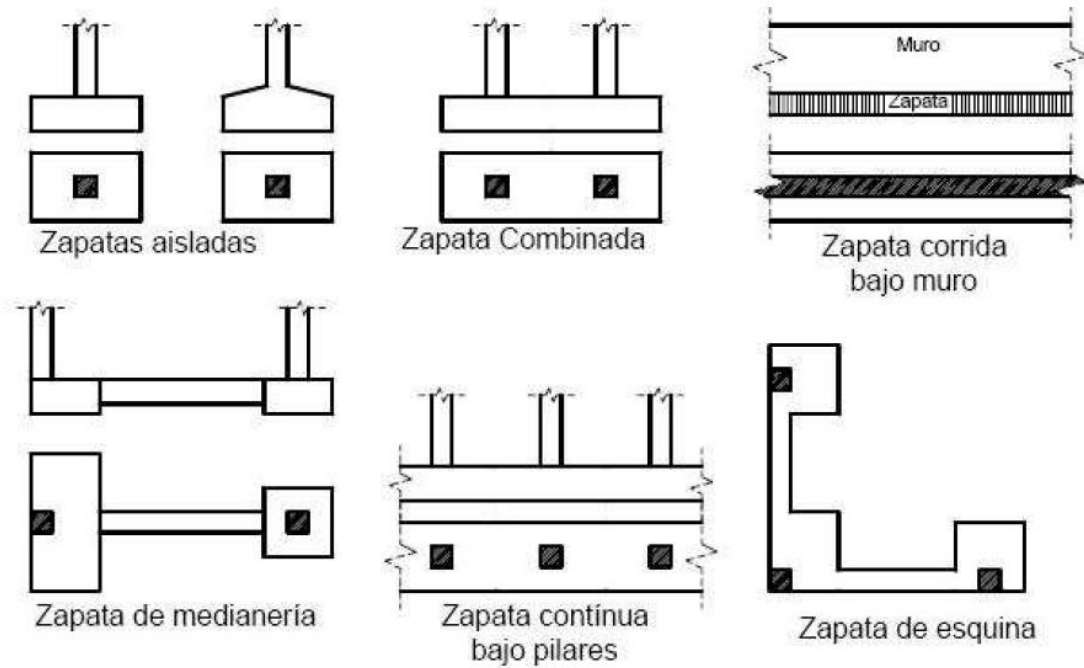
Tipos de zapatas según su forma de trabajo.
